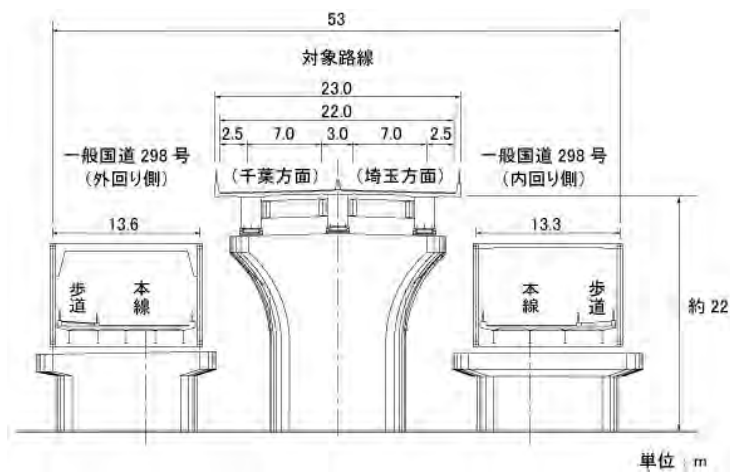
(3) 対象路線代表断面図 (外環葛飾大橋 P163)
